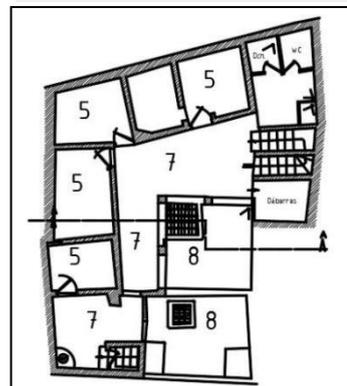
plan d'étage d'habitat traditionnel. Source : Plan modifié par l'auteur
